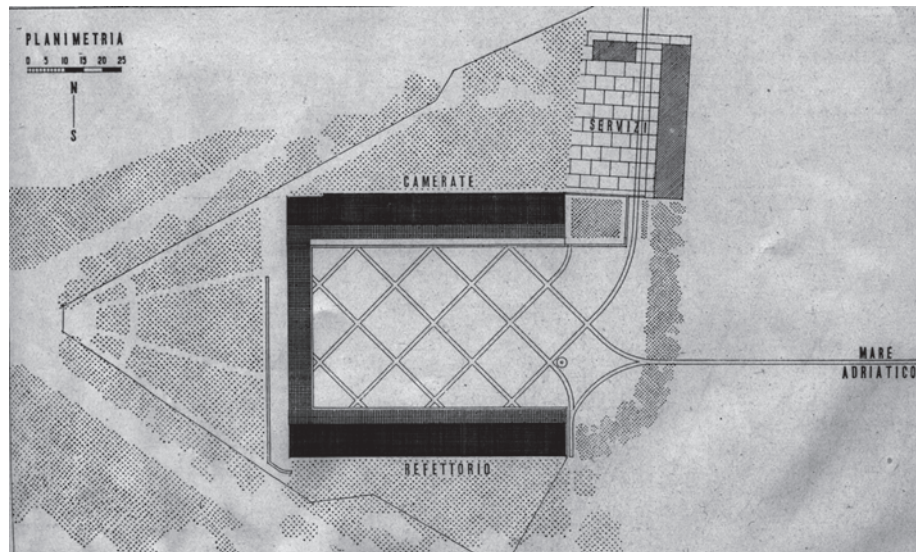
Ferienkolonie „Principe di Piemonte“: Lageplan
